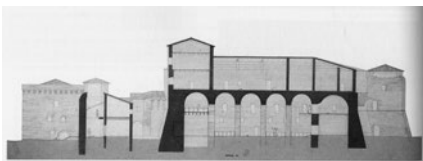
Sezione dal progetto di restauro del Castel Sismondo (in basso).
